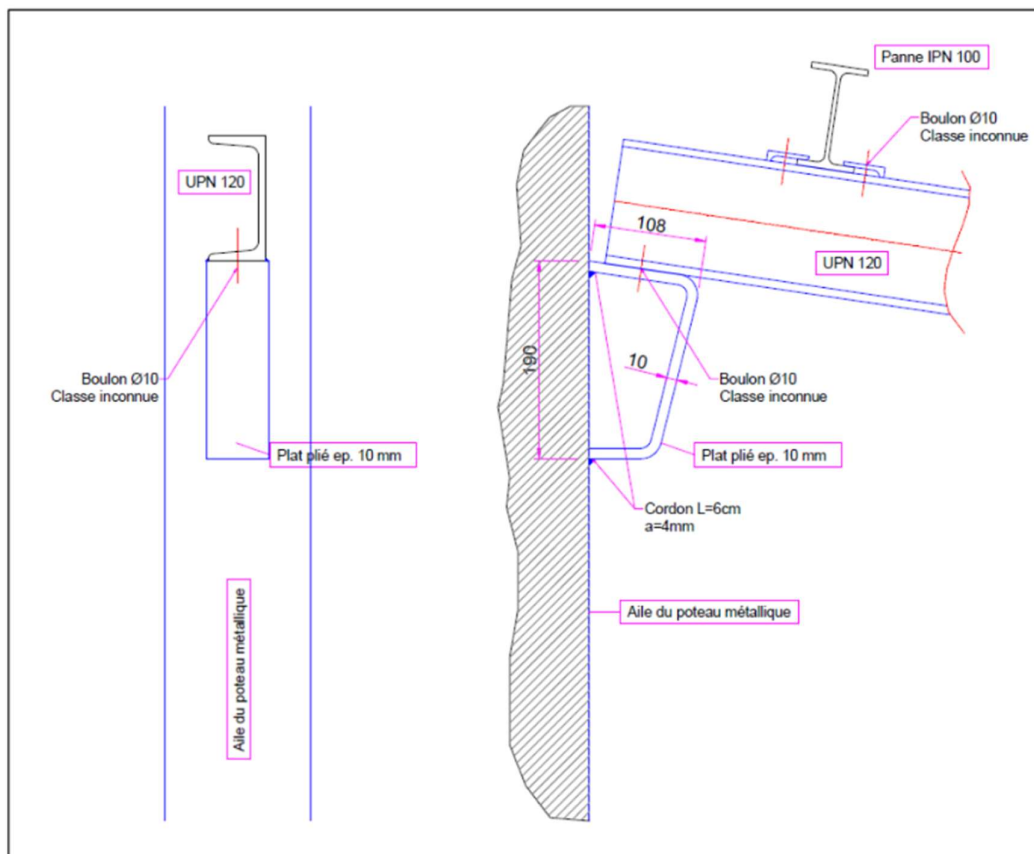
Vues d'un assemblage sur le mur du bâtiment 118
